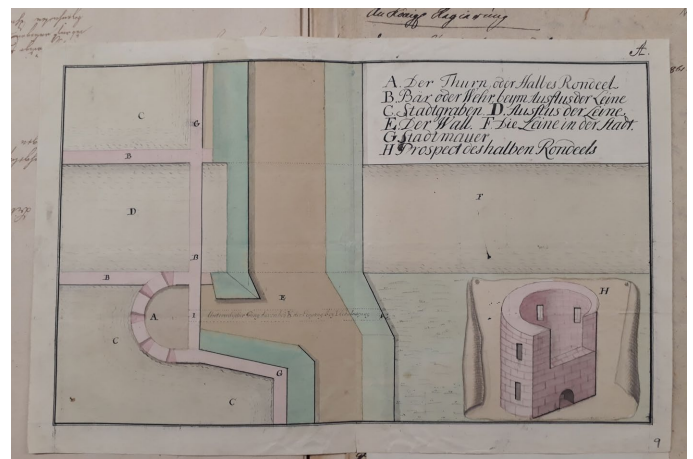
Plan zum Umbau des Stadtturmes am Leinekanal zu einem Bücherdepot, 1763
